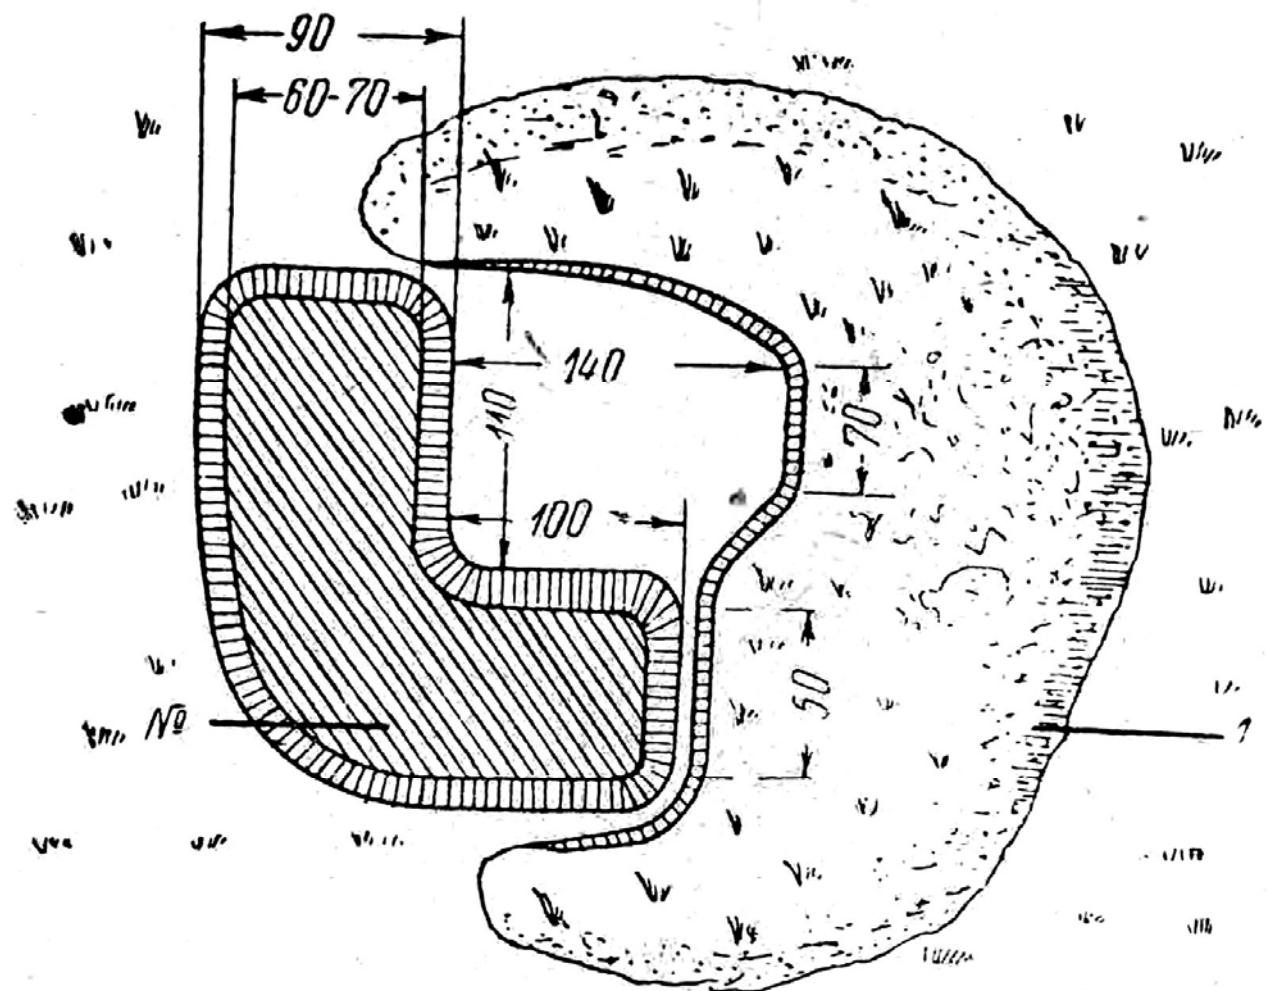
Ячейка для стрельбы с колена из станкового пулемета.
